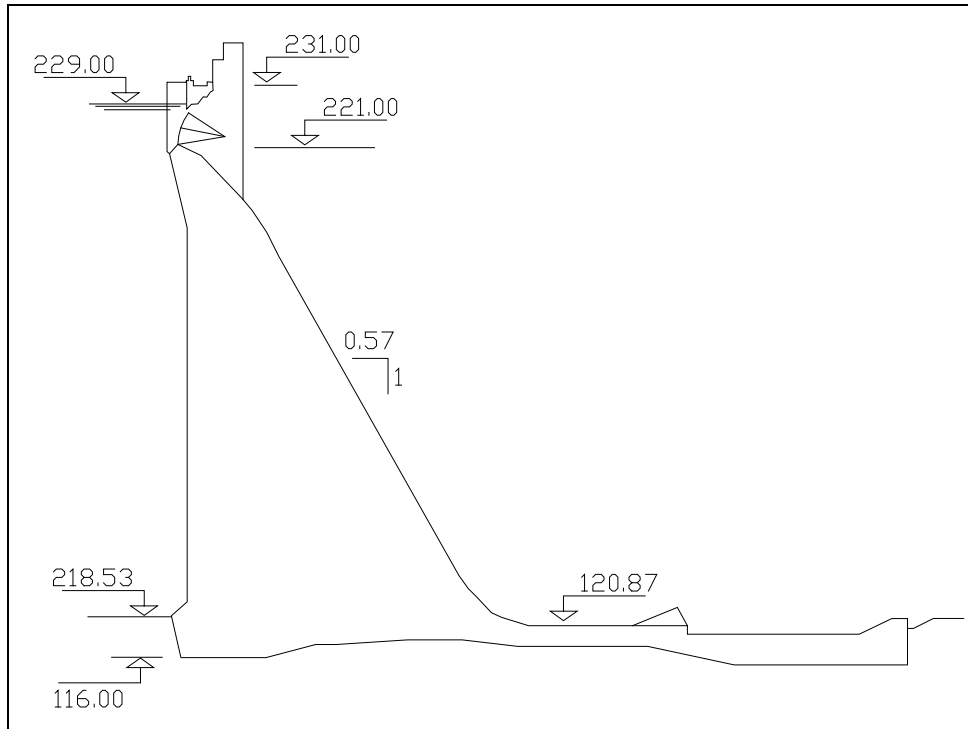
Sección transversal de la estructura de la presa San Esteban. Escala 1:1750.
